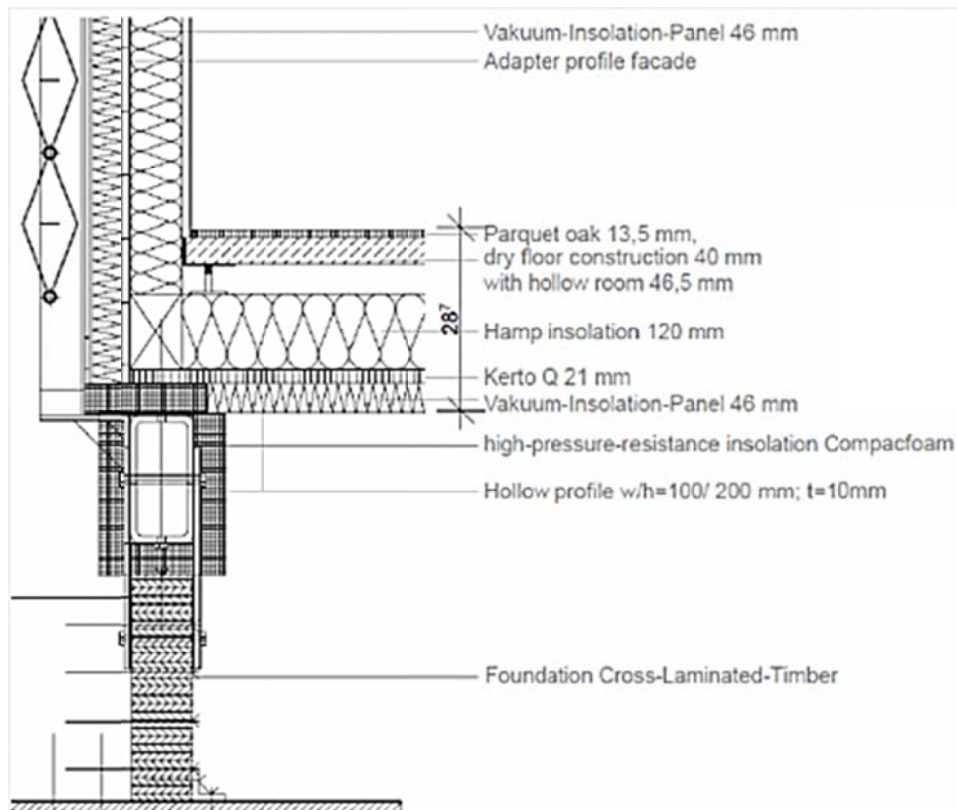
Sección encuentro fachada con forjado. Fuente: ROS_CD_2010-09-21
